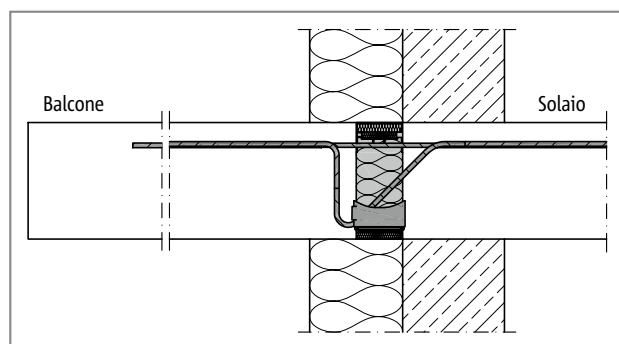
Schöck Isokorb® T tipo KL: raccordo con sistema di isolamento a cappotto
